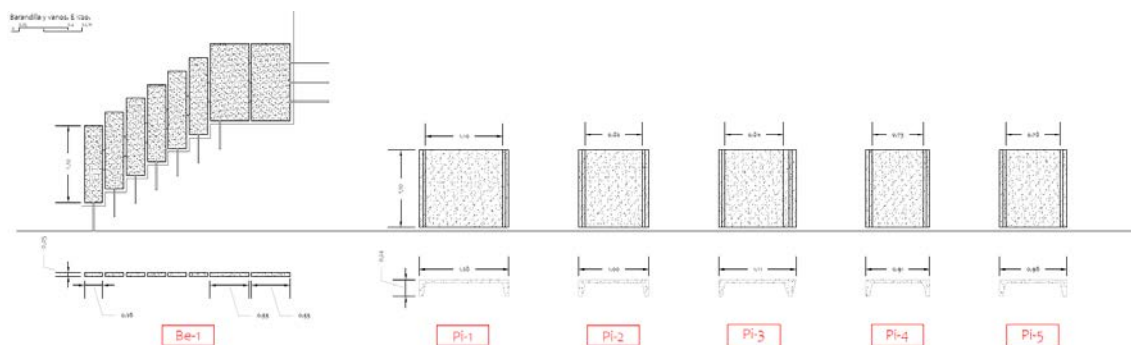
Alzados de barandillas protectoras de escales y vanos.
